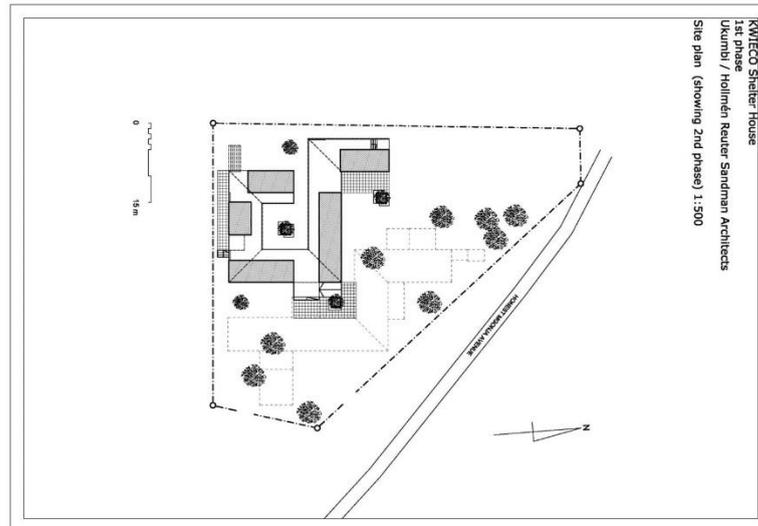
Planta de Implantação do Projeto kwieco, Fonte: Archdaily Brasil.
